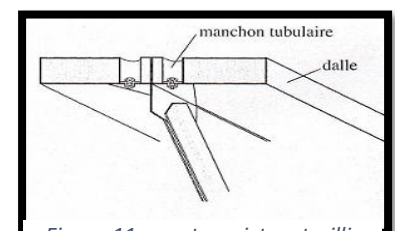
poutre mixte a treillis avec dalle préfabriquée
